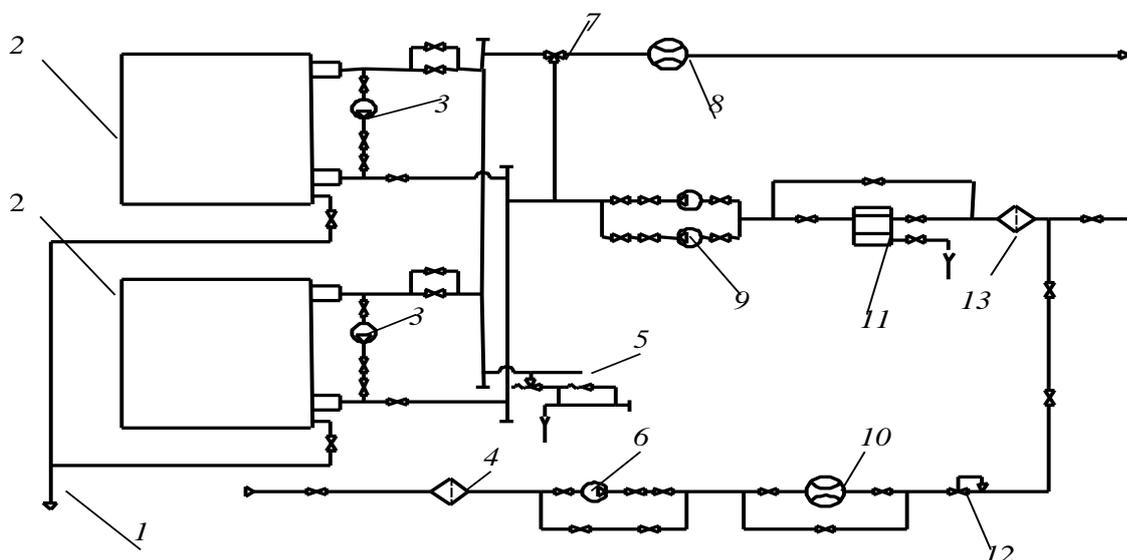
Схема трубопроводов котельной без разделительных теплообменников
